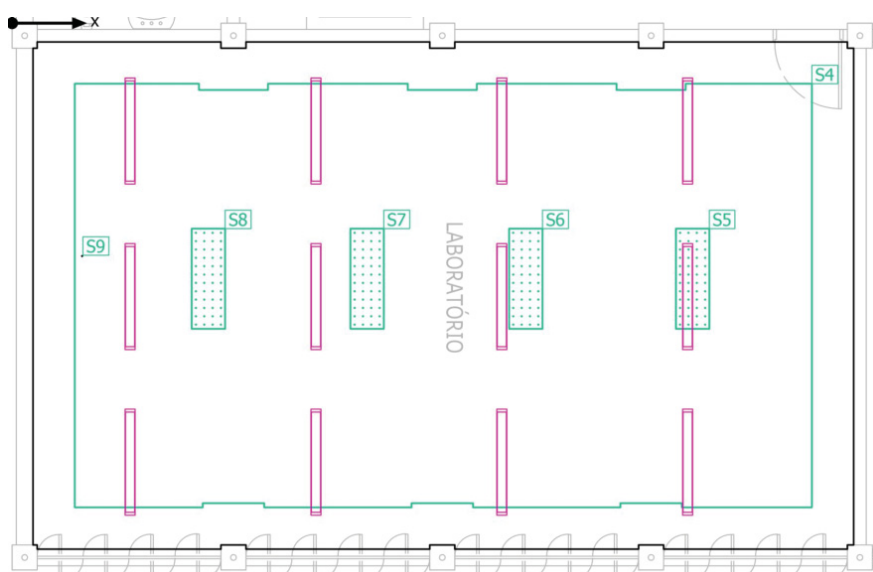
Recorte da planta luminotécnica vigente visualizando a sala de aula noturna.
